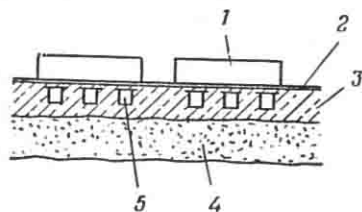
Схема бетонной площадки с паропроводящими каналами:
